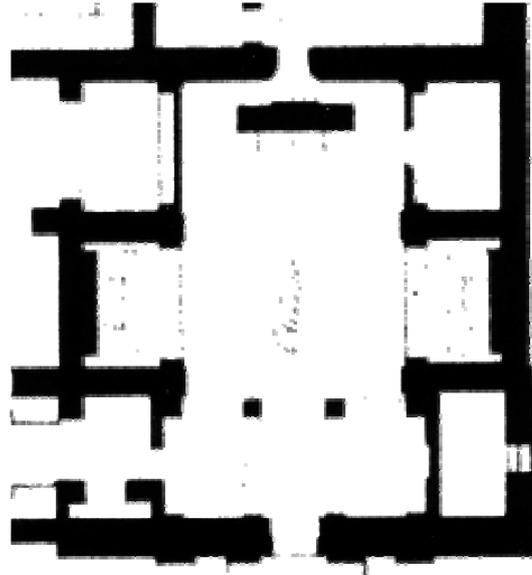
Particolare della planimetria della chiesa da D. Rossi, *Progetto ... del Real Convitto*, 1851 (da NIGRO).
